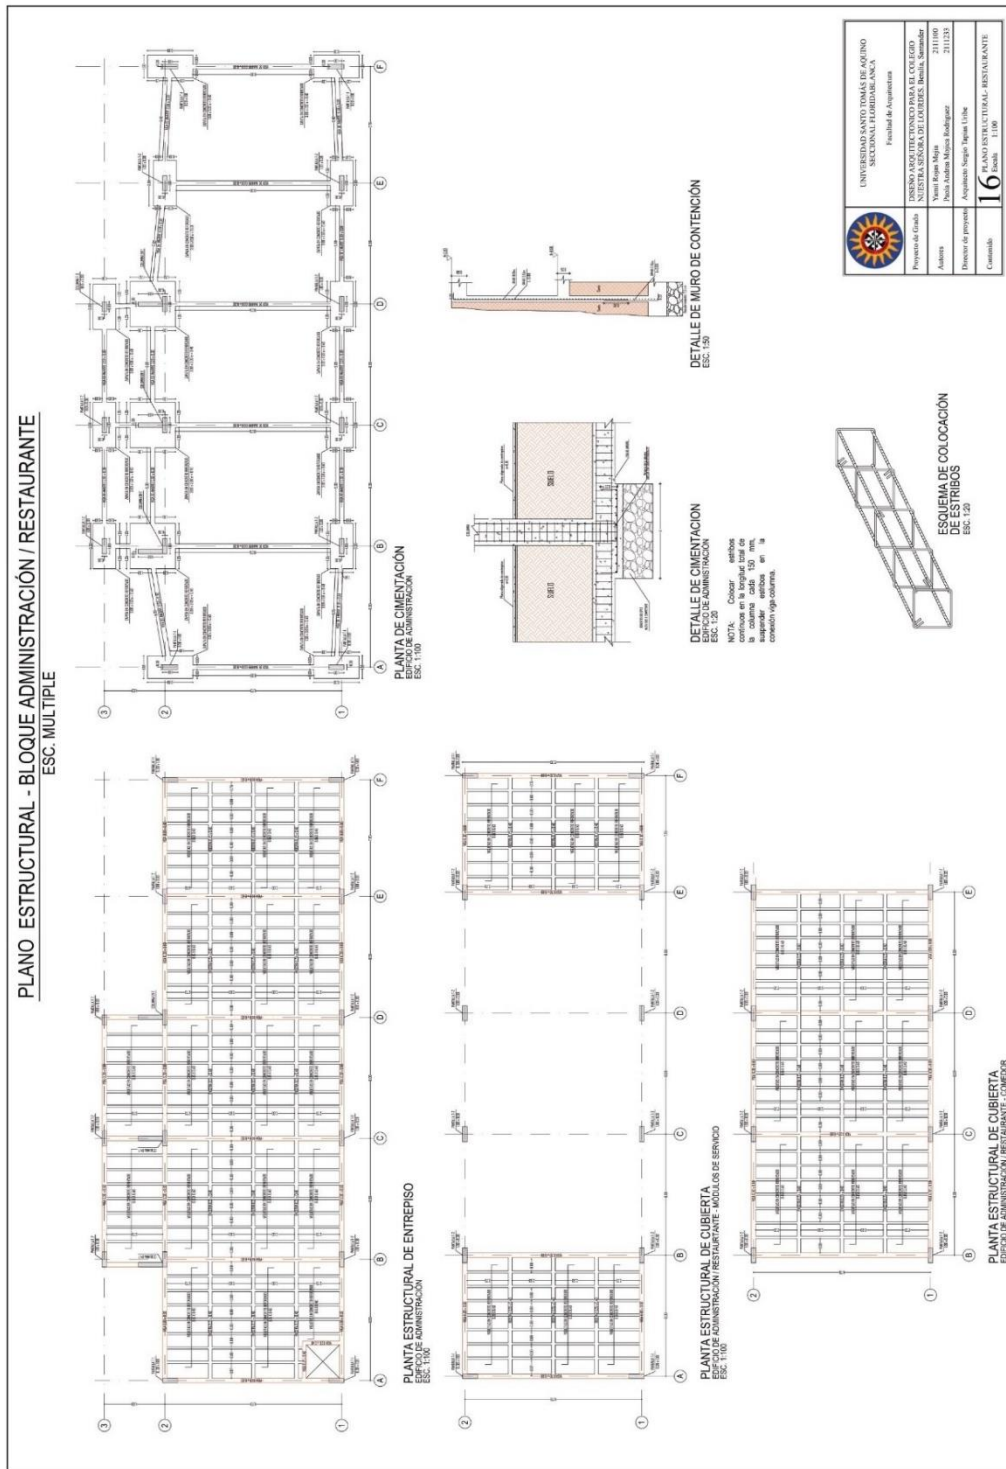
Plano estructural modulo Restaurante-Administración-Servicios
